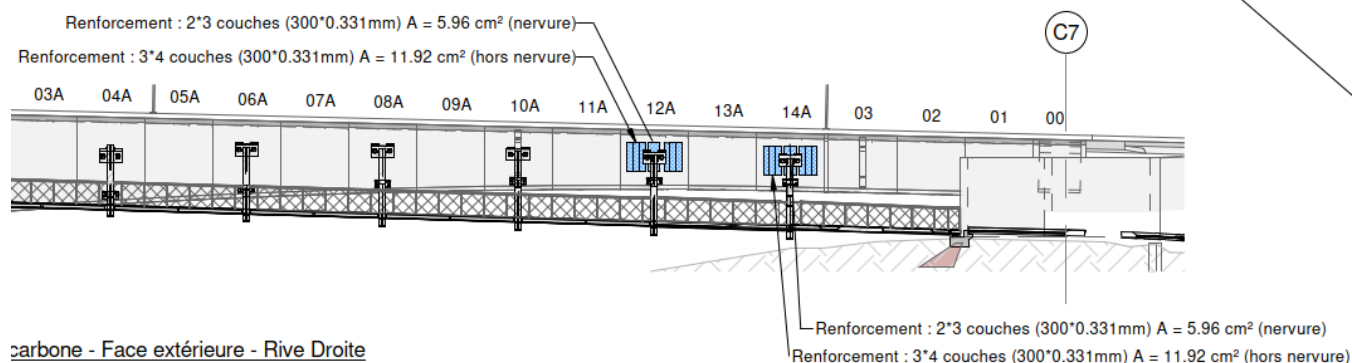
Renforcement en tissu de carbone sur travée de rive droite - extrait du cahier de plan technique PRO
